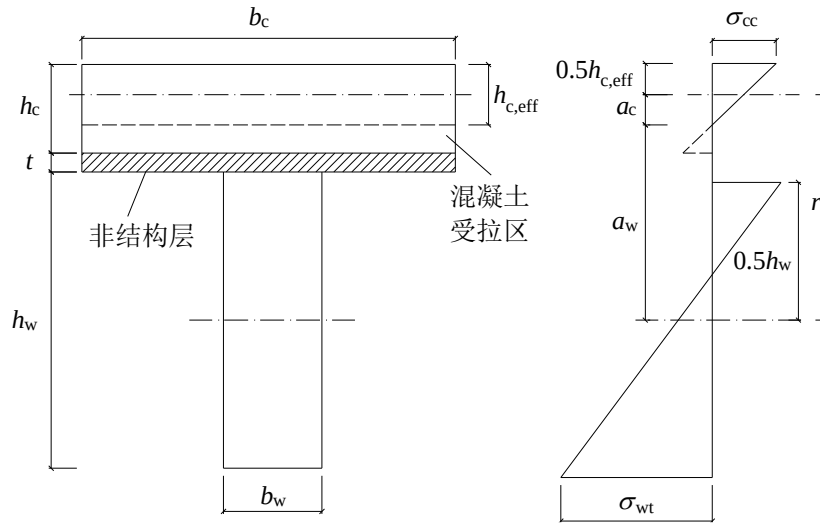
正弯矩作用下木-混凝土组合梁横截面和应力示意
